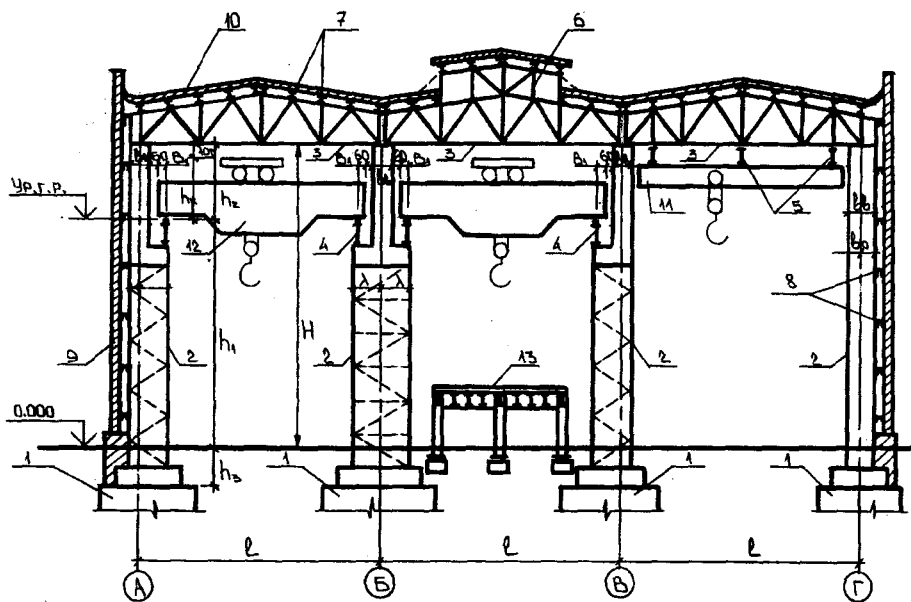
Поперечный разрез трехпролетного промздания:
